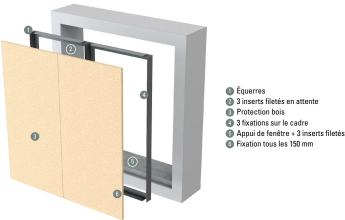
Exemples de protection provisoire non poreuse (cas 3)
